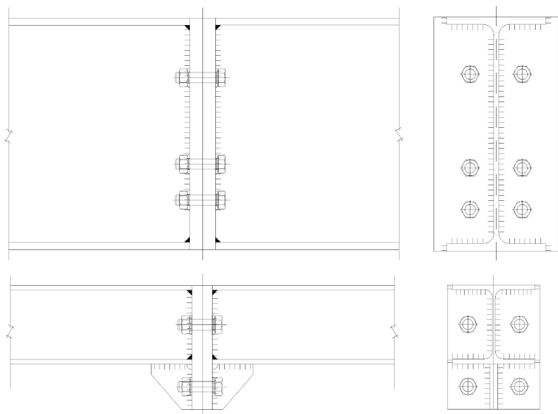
Detalle de conexión atornillada en vigas metálicas de diferentes tamaños
